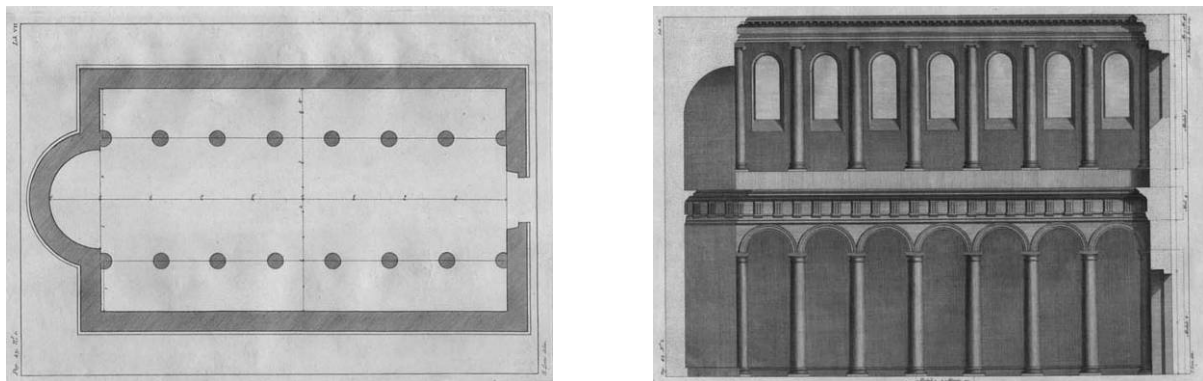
Planta e corte 'padrões' para um salão, apresentados por Palladio.
